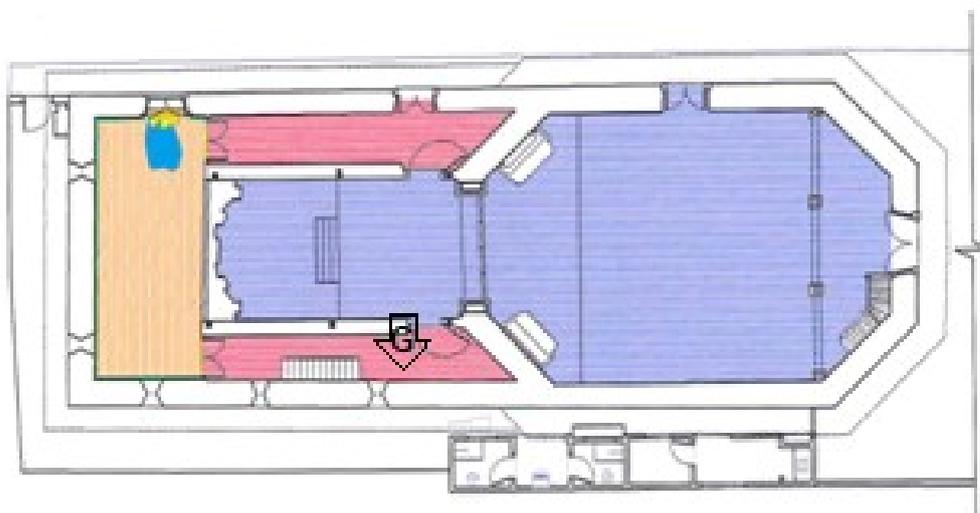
Vista G - Corredor lateral esquerdo - Planta pavimento inferior Capela Sem escala.
